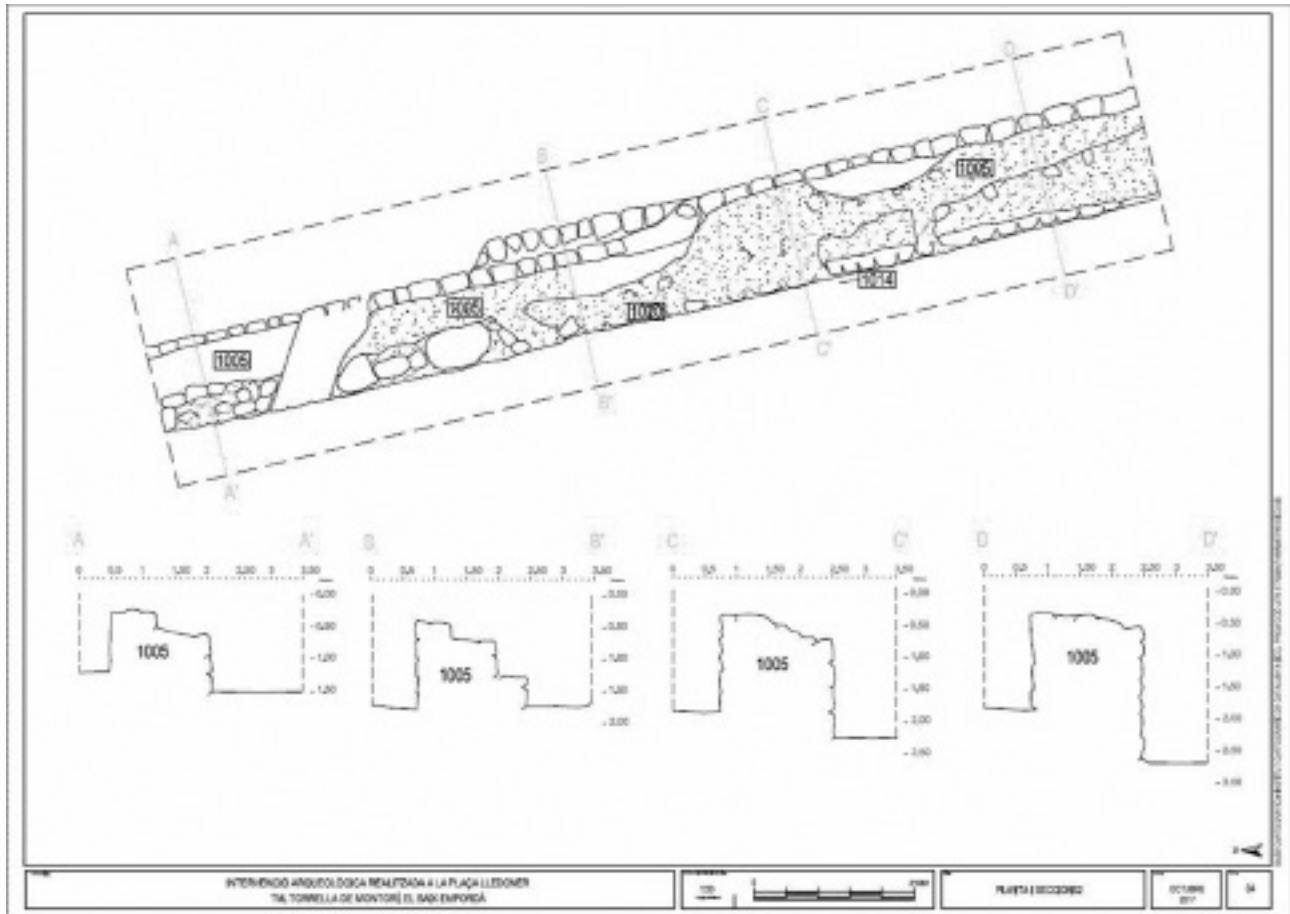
Planta i seccions del tram de muralla documentat (Plànols: Bertha Durà).
